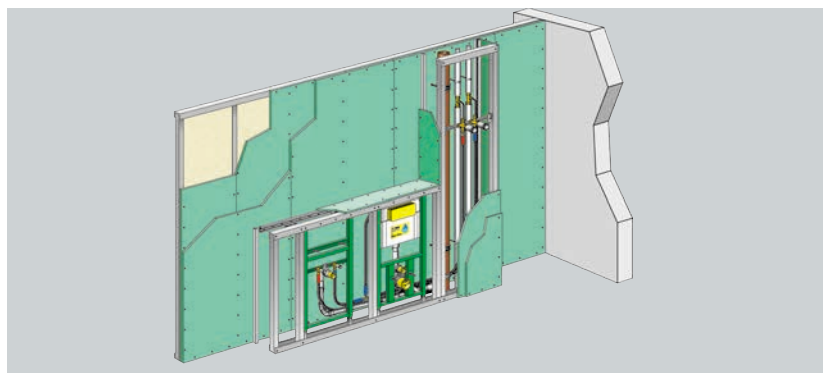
176 Viegas Eco Plus na parede de estrutura leve
